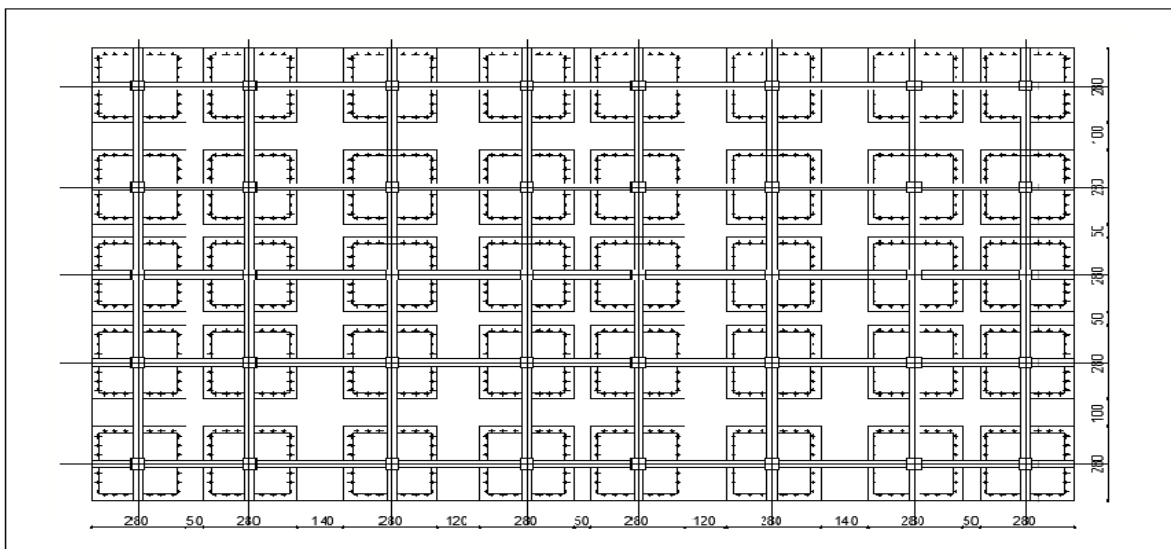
Plaque supérieure fixée au droit de chaque poteau au niveau du plancher haut du vide sanitaire
